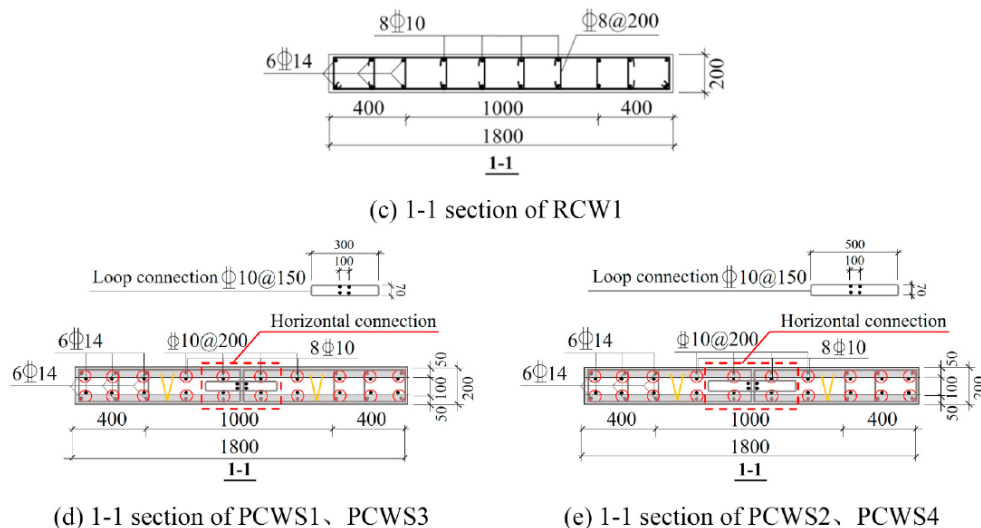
Secções transversais da parede moldada *in-situ* e parede dupla [19]
